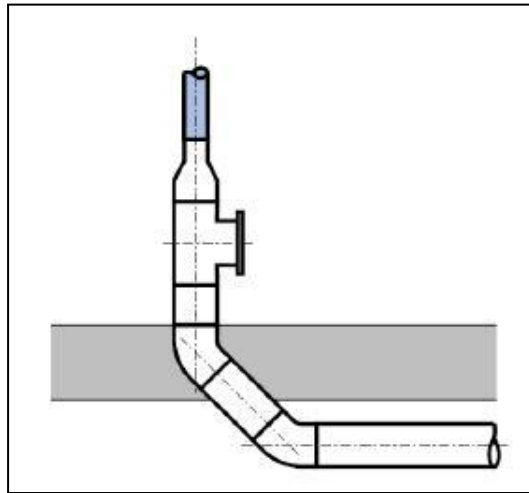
Entrada em sistema gravítico antes do atravessamento da laje de fundação[22]
